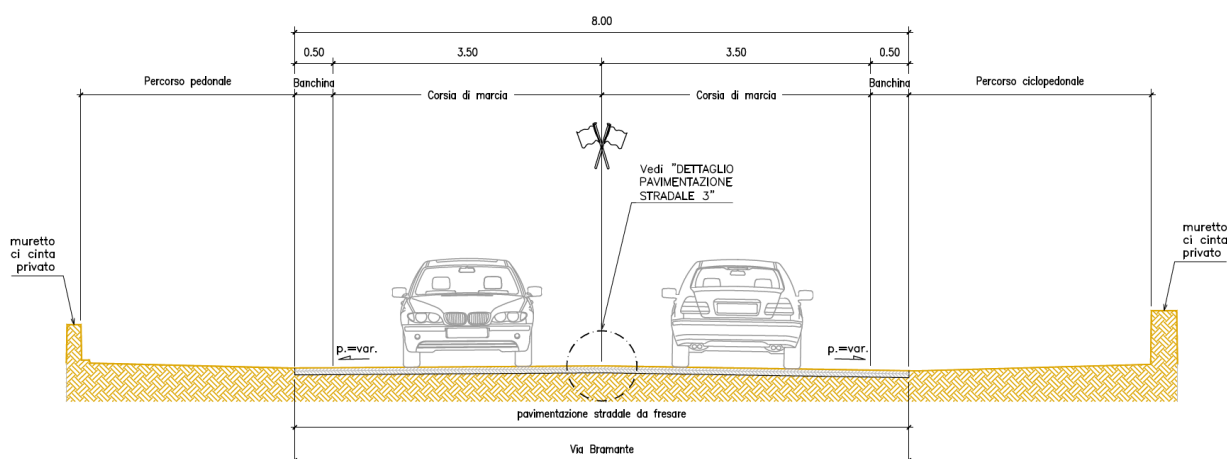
Sezione tipo sulla sede stradale di Via Bramante (Asse C)
